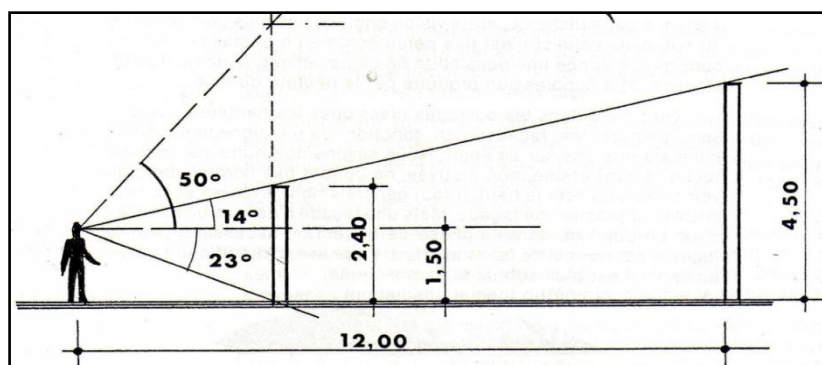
Le rapport entre la distance d'éloignement et la hauteur de la façade.
